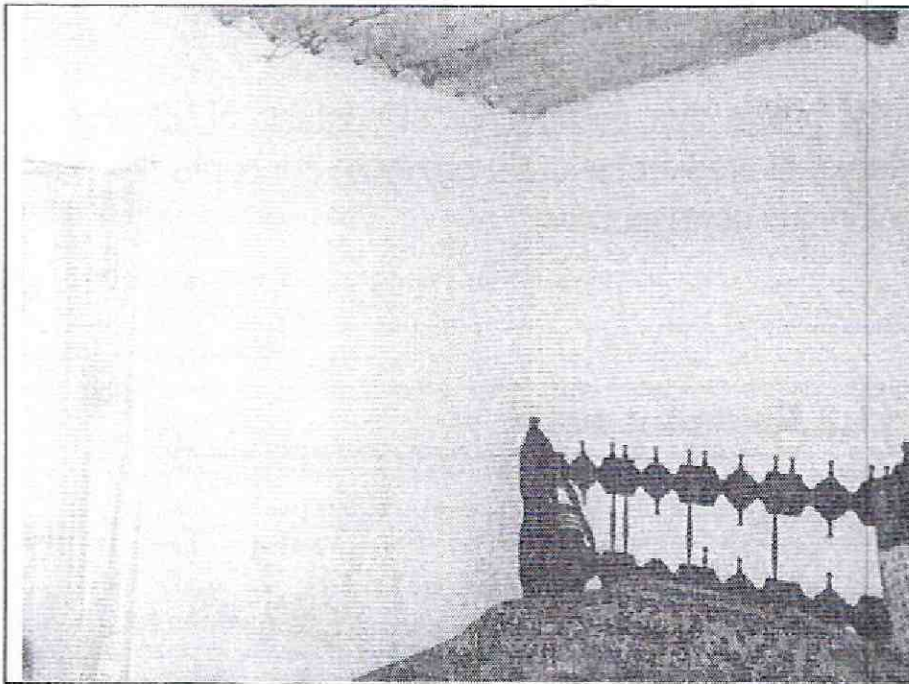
Vista interior sector alcoba localizado en el costado norte. No se observa daños.
